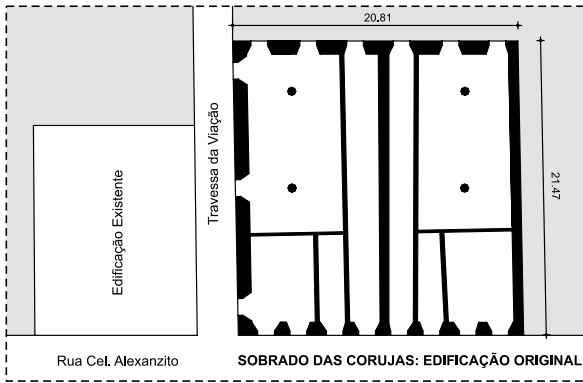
croqui da planta do Sobrado, por João José Rescala, 1941. Fonte: (Arquivo Central do Iphan-RJ).
